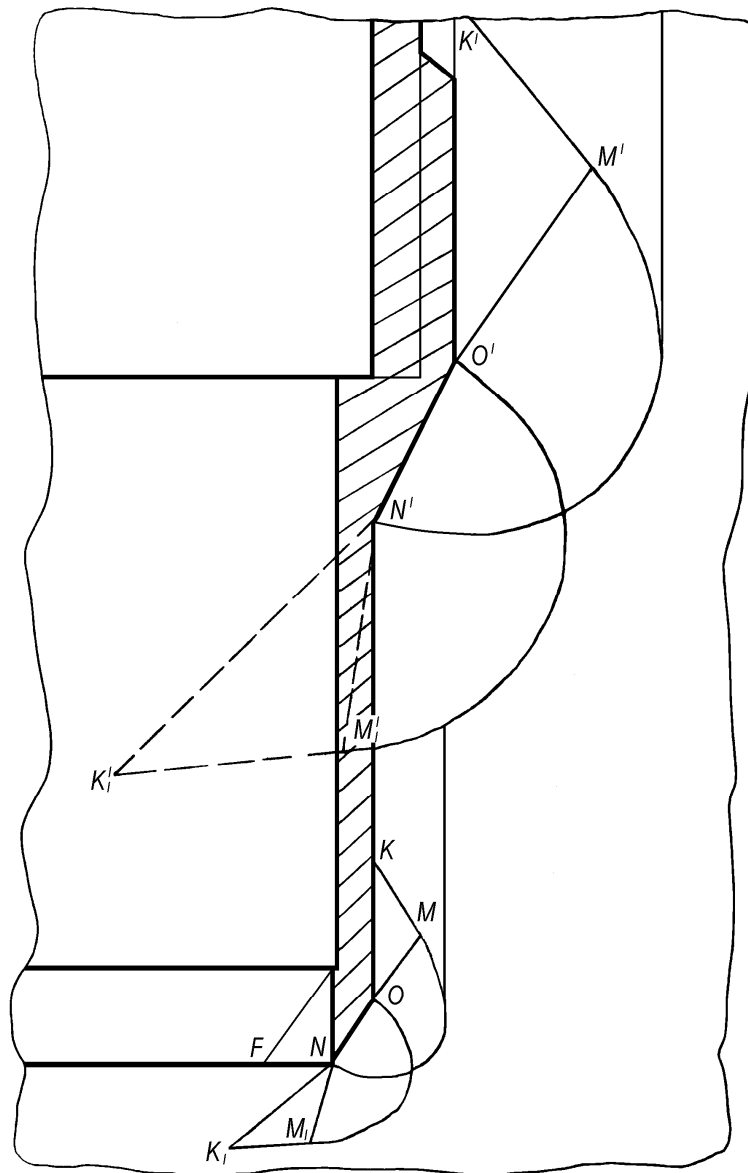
Схема развития областей нарушения грунта при вдавливании грунтоноса с двухступенчатой конусной наружной поверхностью башмака
